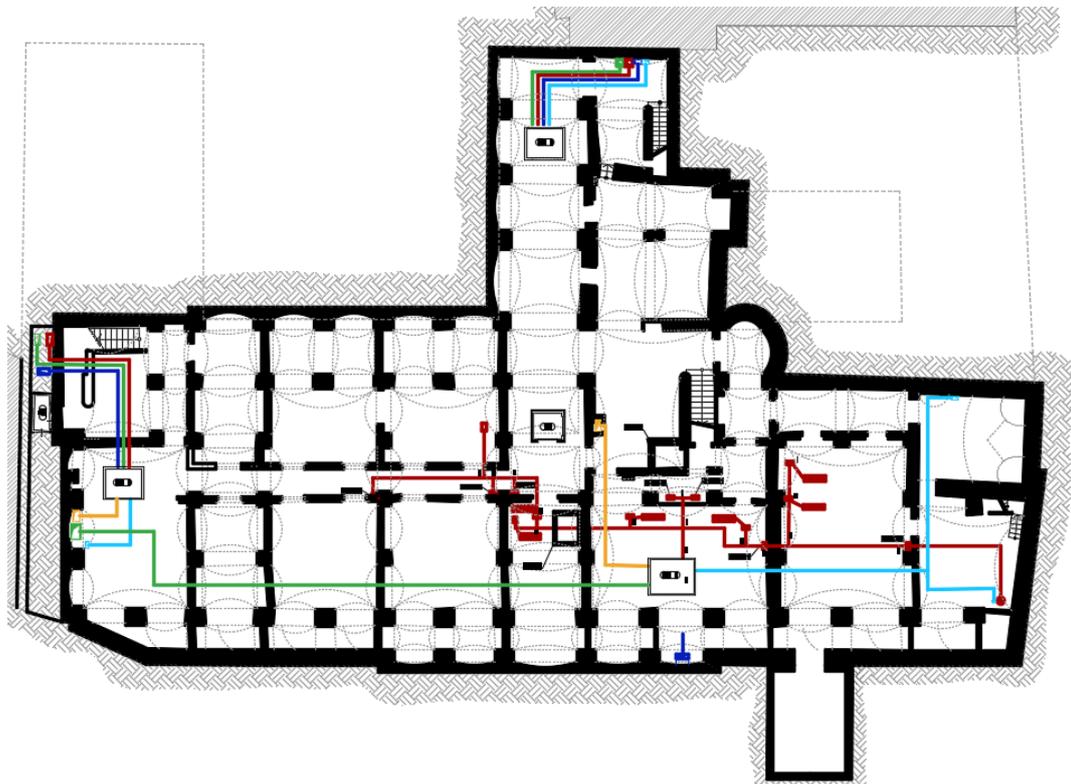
Pianta del piano interrato, nella quale è visibile una rappresentazione schematica delle canalizzazioni.
